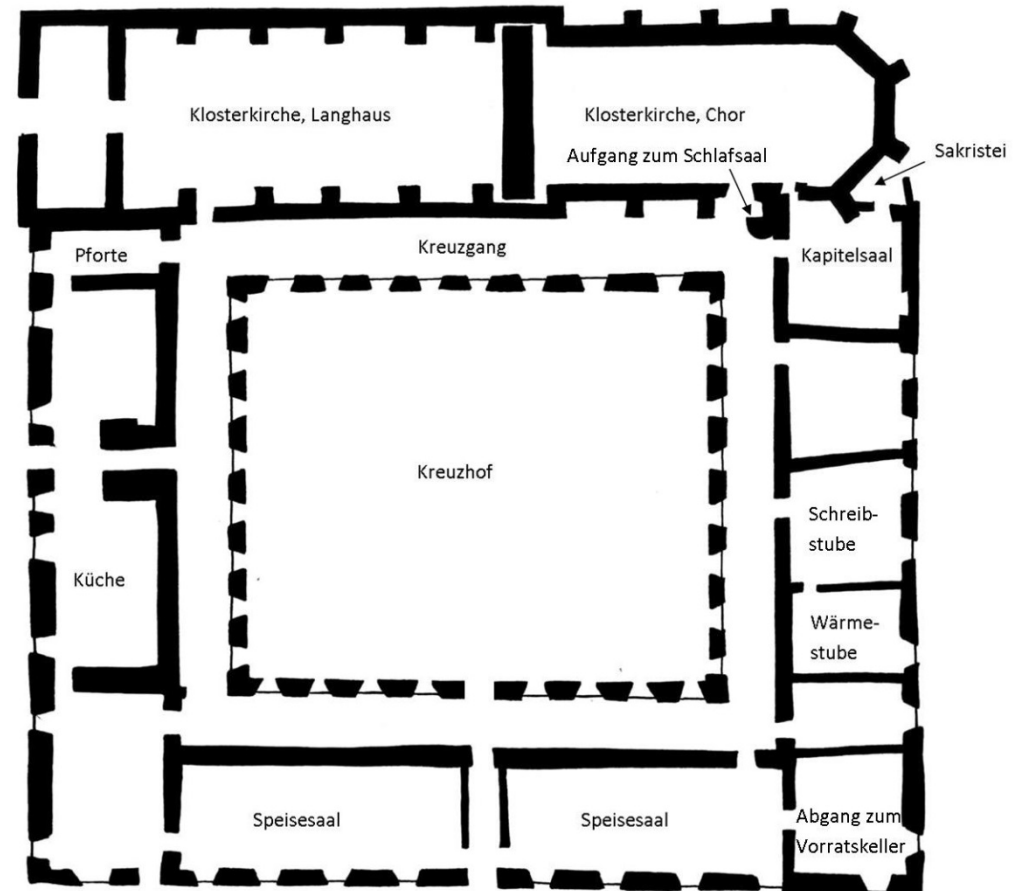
Grundriss der Klausuranlage Kloster Dalheim im Mittelalter. © Stiftung Kloster Dalheim
